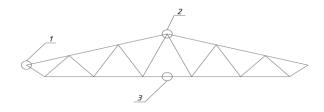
Схема размещения рассчитываемых узлов фермы
